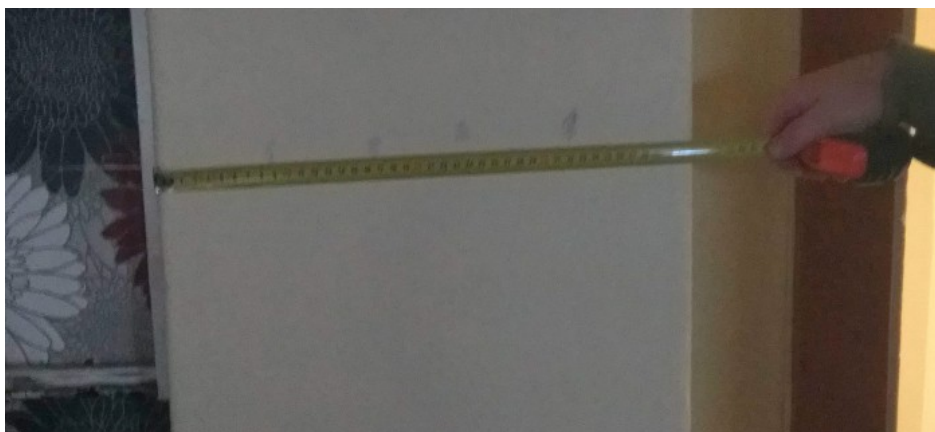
Detekcja zbrojenia słupów żelbetowych Segmentu A
